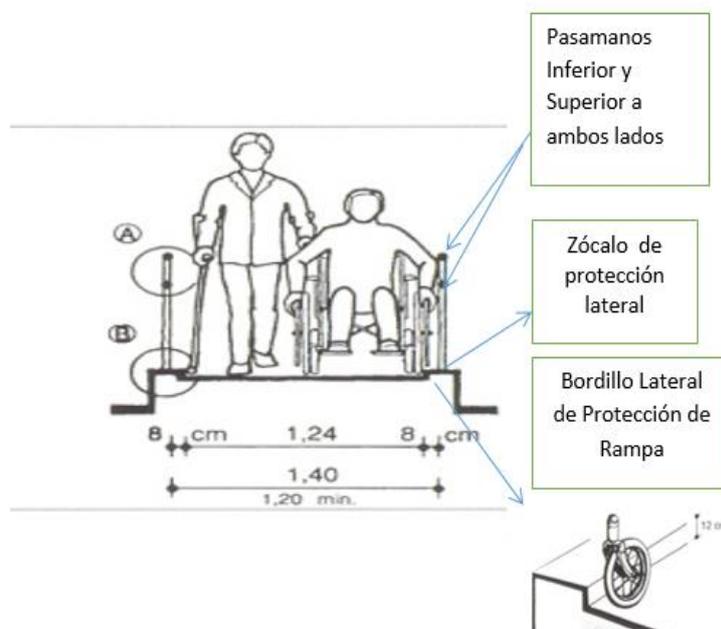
Sección rampa de Acceso a Edificio. Fuente: (Pierre, 2003).
